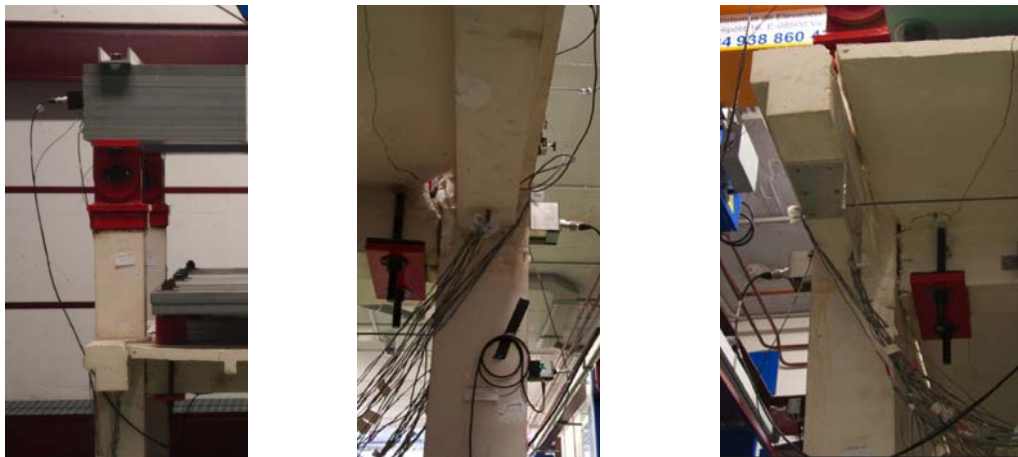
Representación de macrofisuras en el nudo de unión del pilar con la viga.
